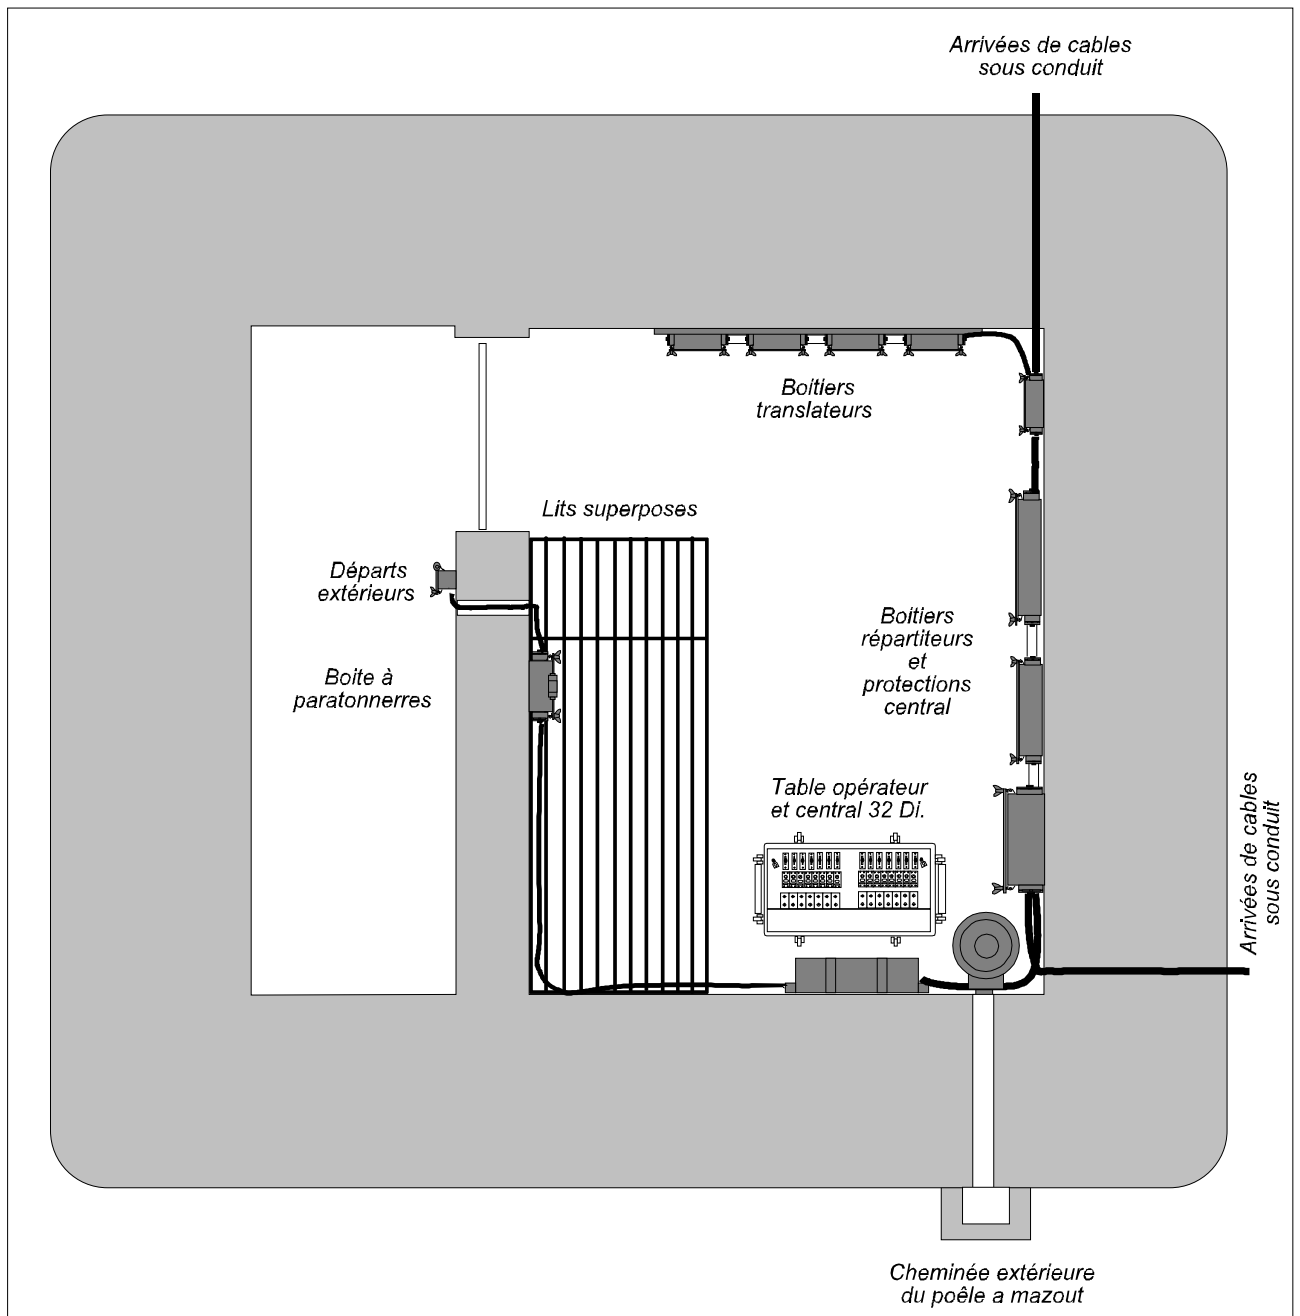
Plan de la chambre 11A à proximité de l'ouvrage du Mottenberg
